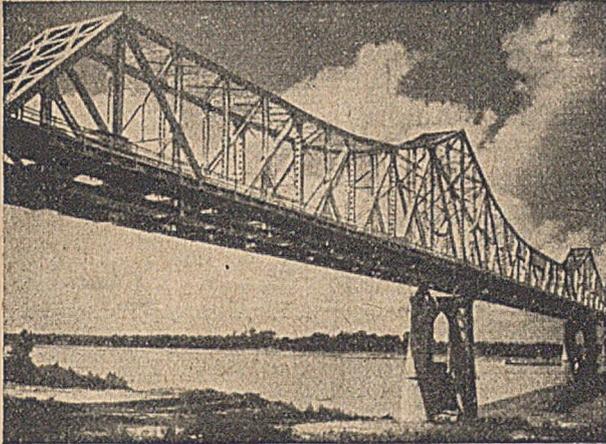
Gerberbalken über den Mississippi bei Baton Rouge (1941, Mittelöffnung 260 m).
